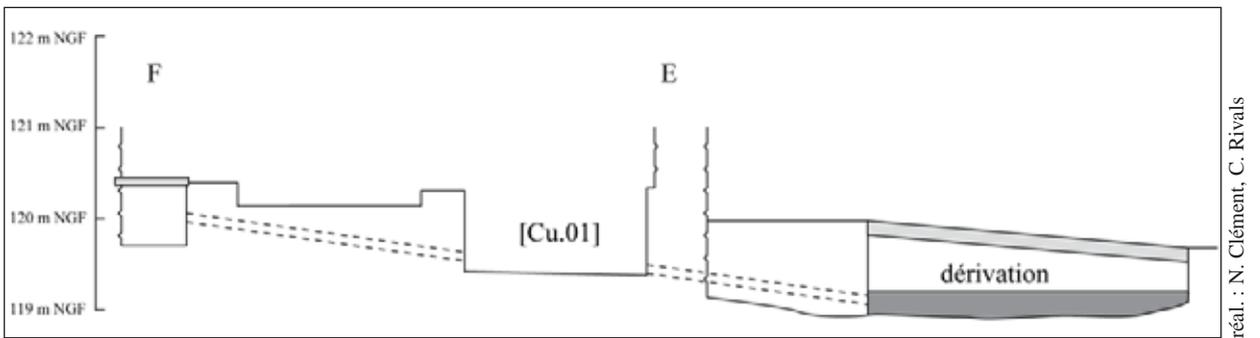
coupe [FE] (est / ouest) du rez-de-chaussée
